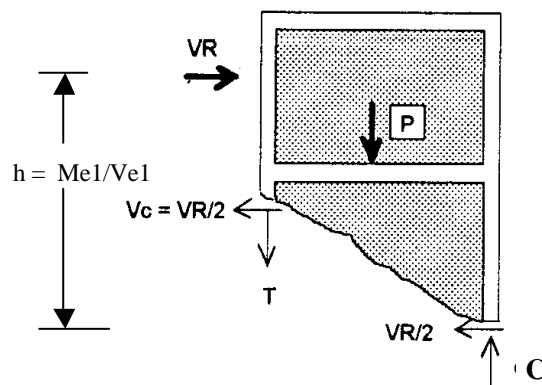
Fuerzas internas en columnas de un muro confinado de un solo paño y en voladizo
